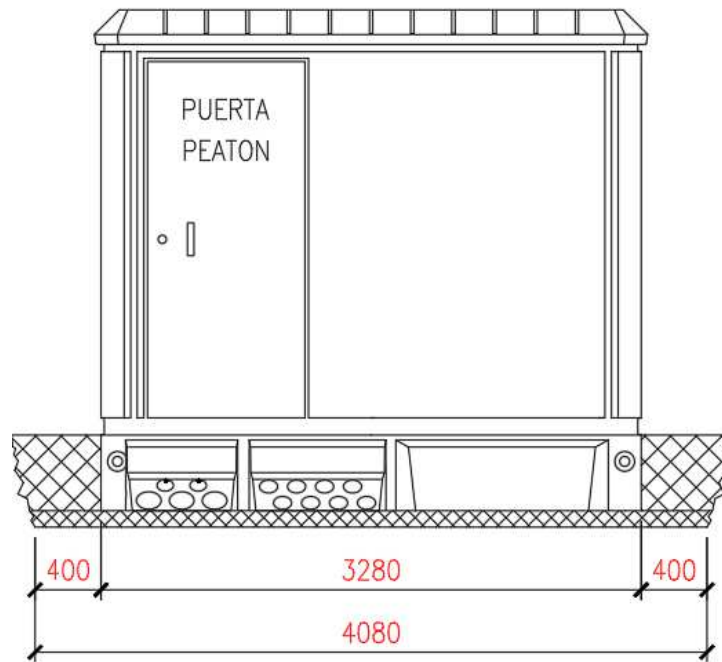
Vista del centro prefabricado de hormigón PFU-3
